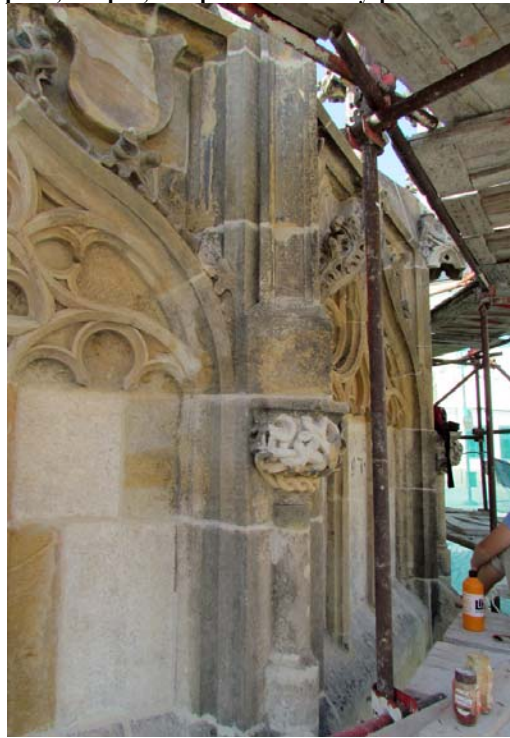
Dokumentace prací, sloupek, stav před restaurováním
